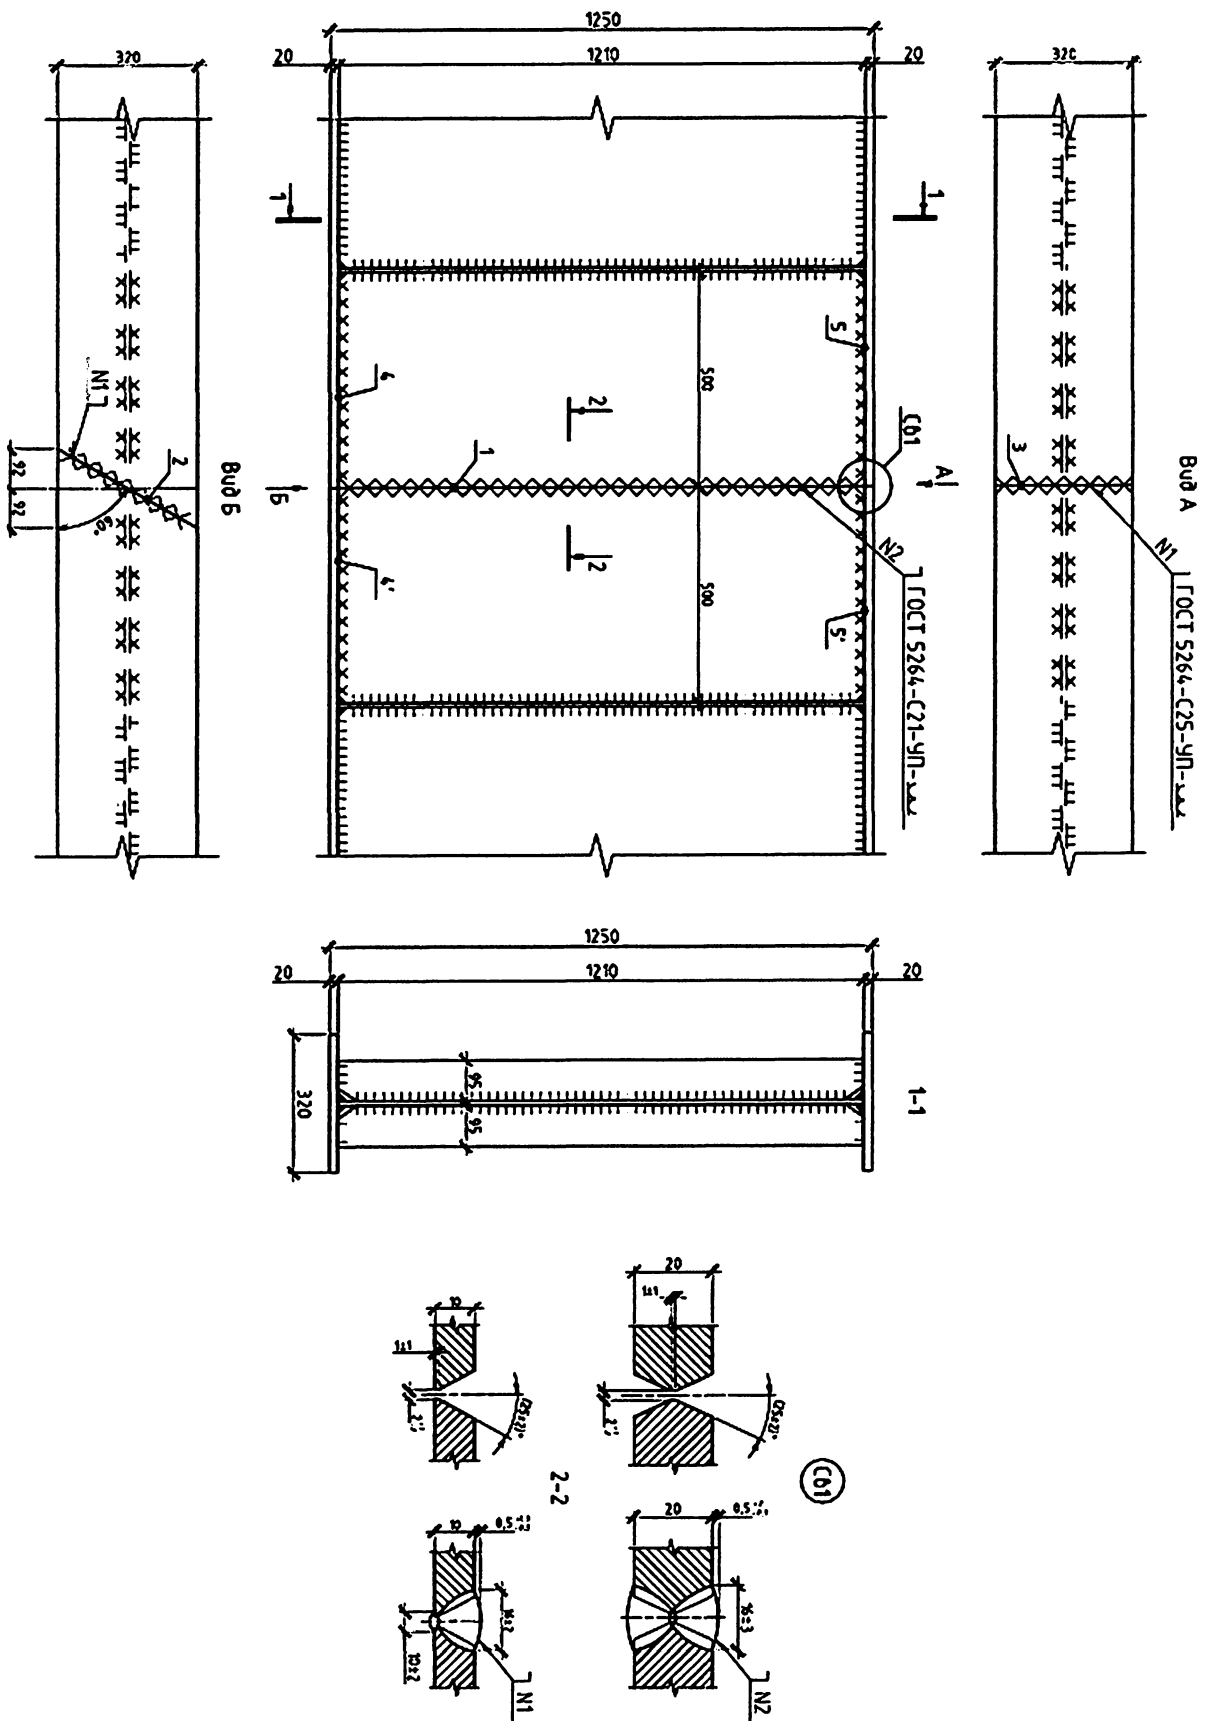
Равнопрочный стык составной балки на сварке
